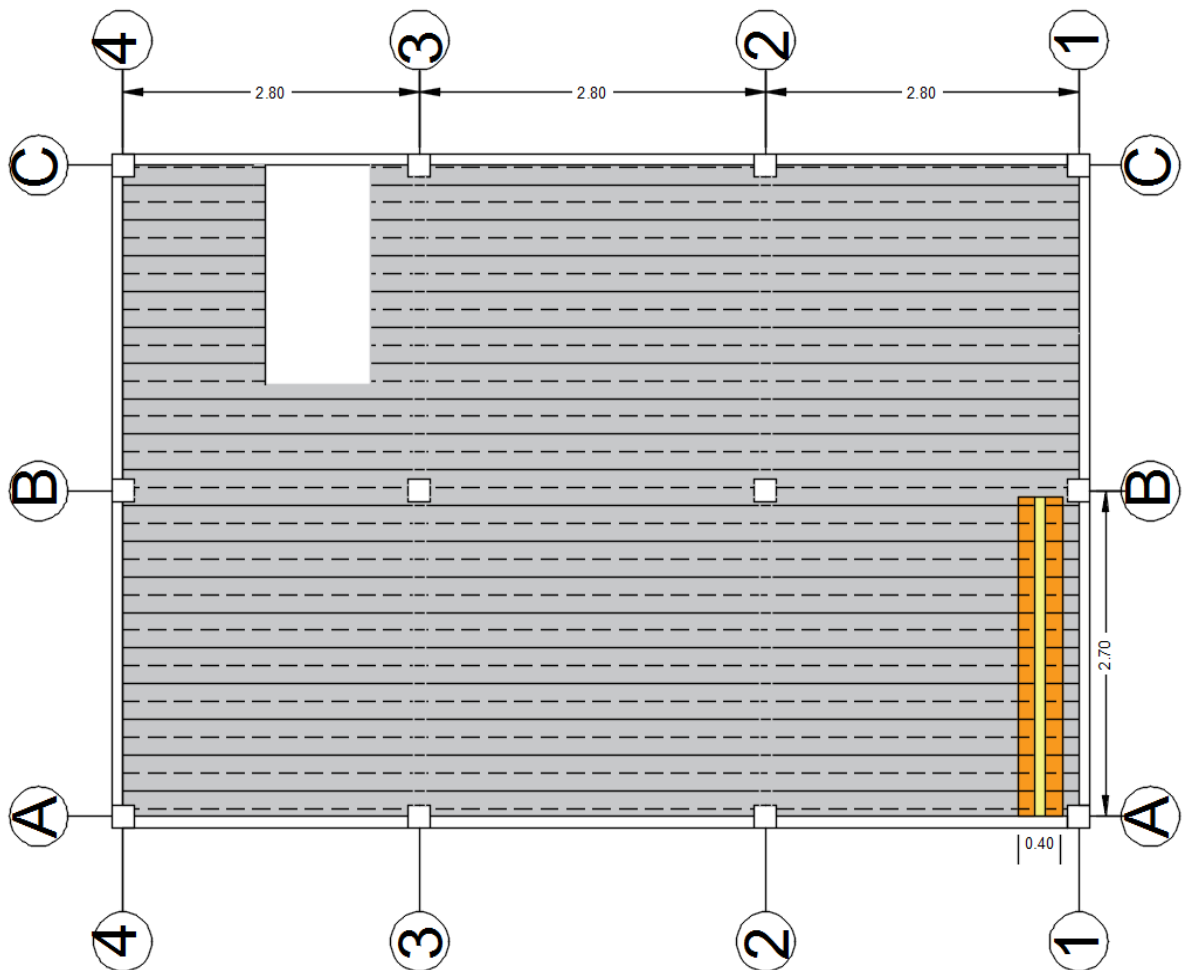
Vista en planta de la viga analizada eje 1 entre a-b
